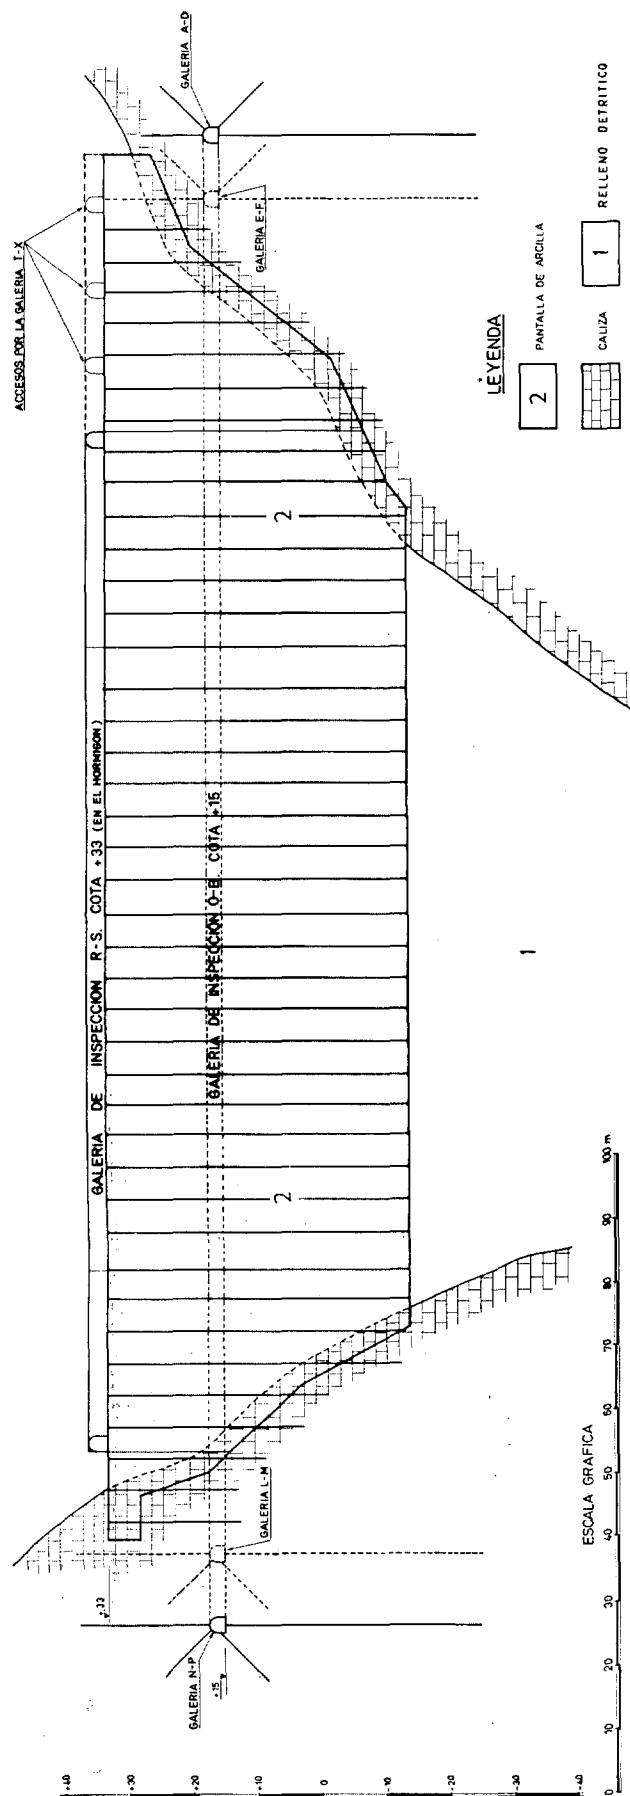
Sistema de impermeabilización del terreno en el pantano de Tous. Desarrollo de la pantalla de arcilla de aguas arriba. Sección-alzado por la galería de inspección R-S. Cota +33.
